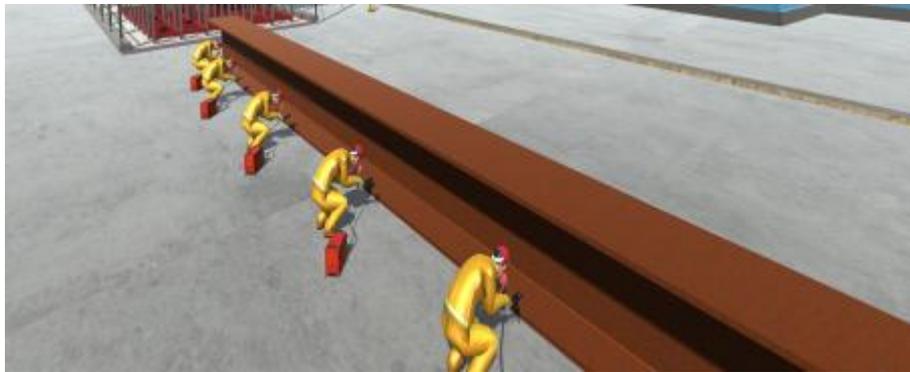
钢筋笼工字型钢摆放定位图
